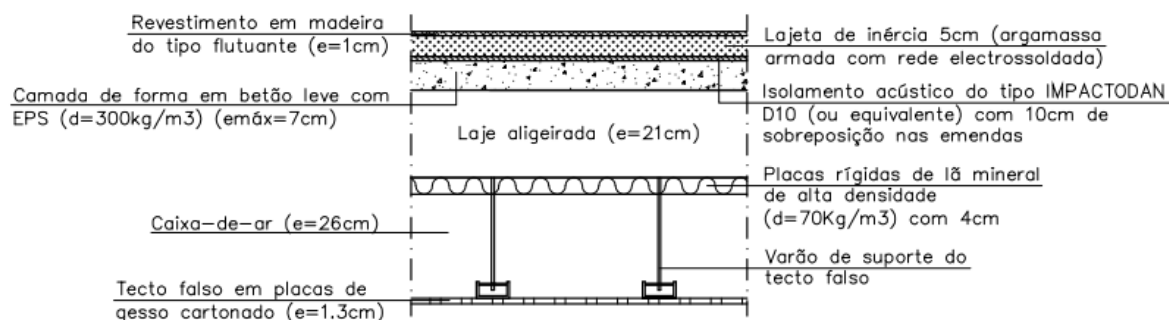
Pormenor construtivo da laje de separação entre comércio e habitação - Pavi3
